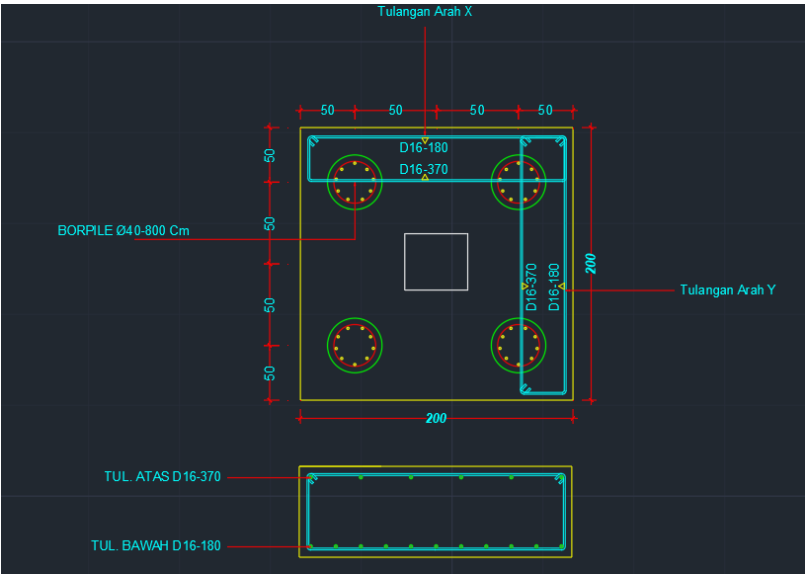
Detail Rencana Pondasi Dan Pile Cap.
